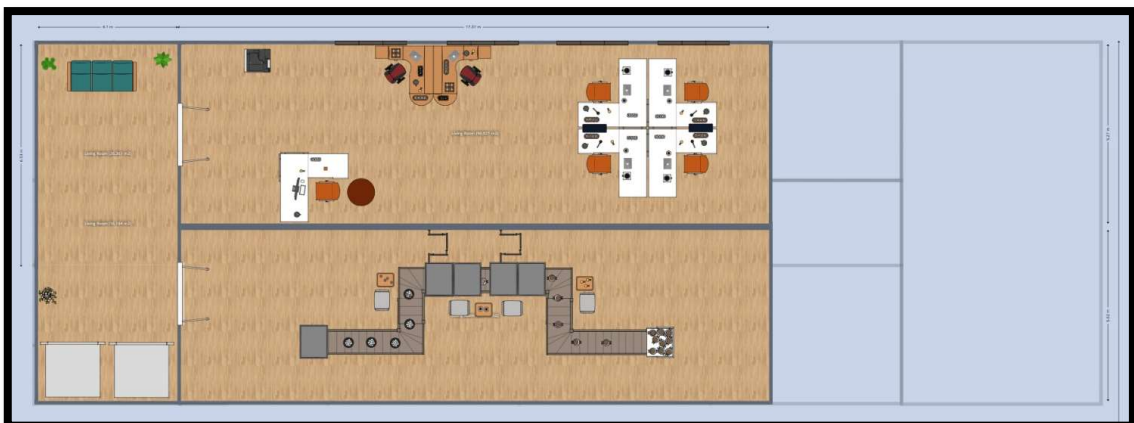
Layout da Recepção e área de lazer dos trabalhadores
